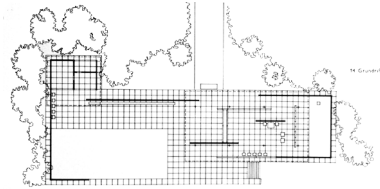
Grundriss Barcelona Pavillon, M.v.d. Rohe, 1929
